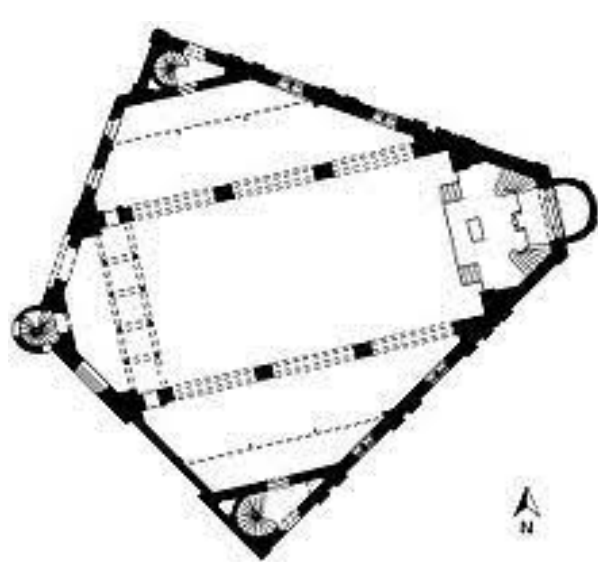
Grundriss Synagoge Leipzig
